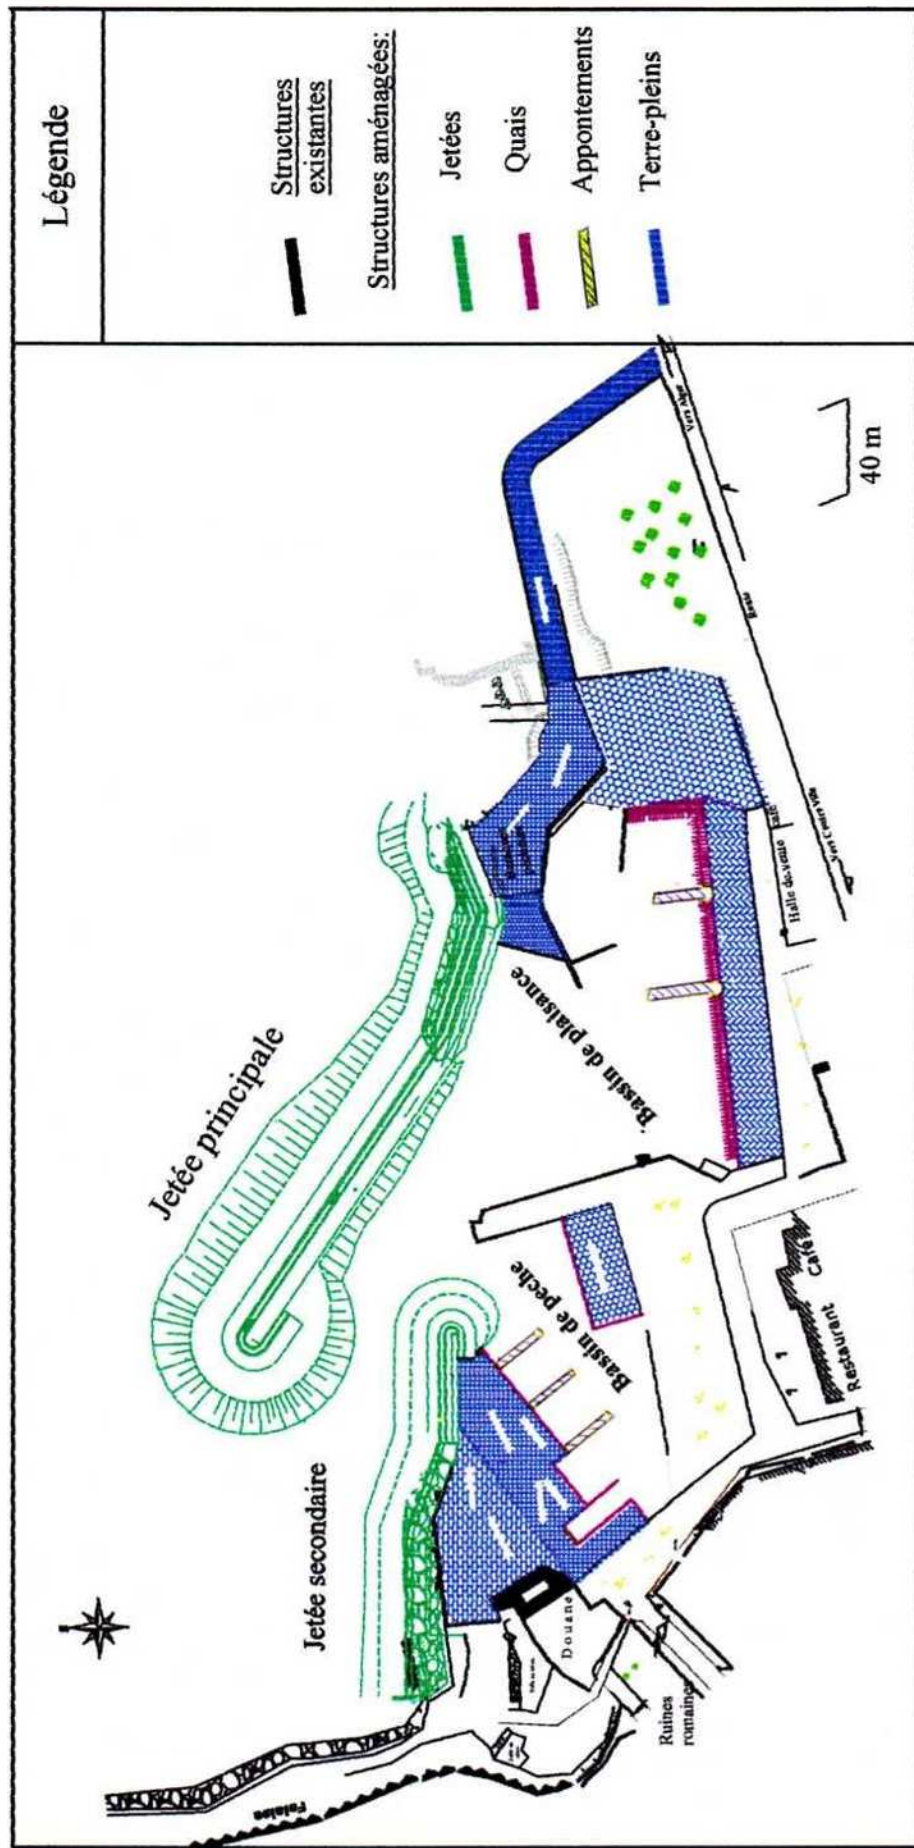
Plan d'aménagement final du port de Tipaza (2009).
